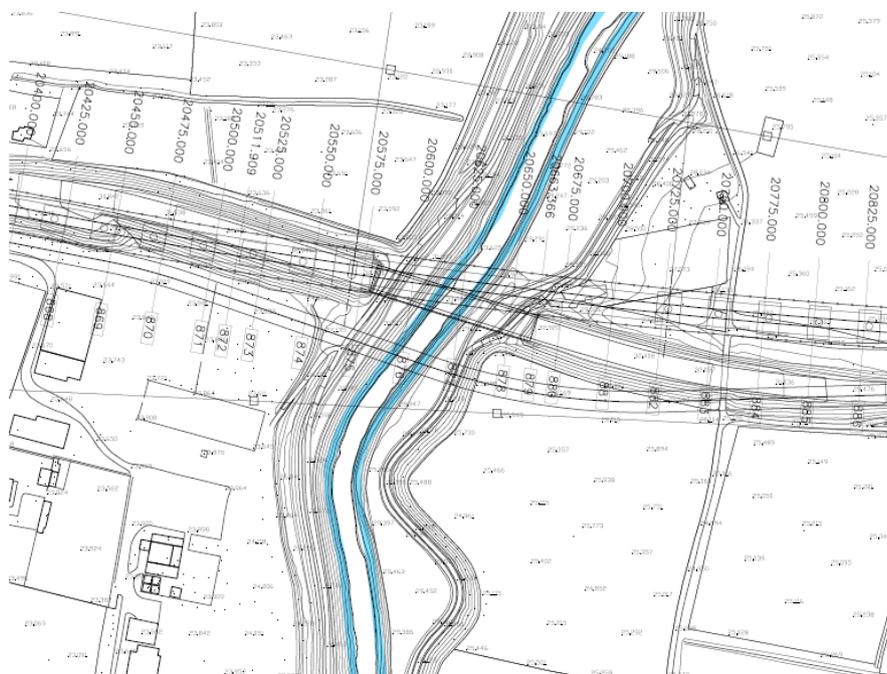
Stralcio planimetrico stato di progetto - Torrente Alpone
